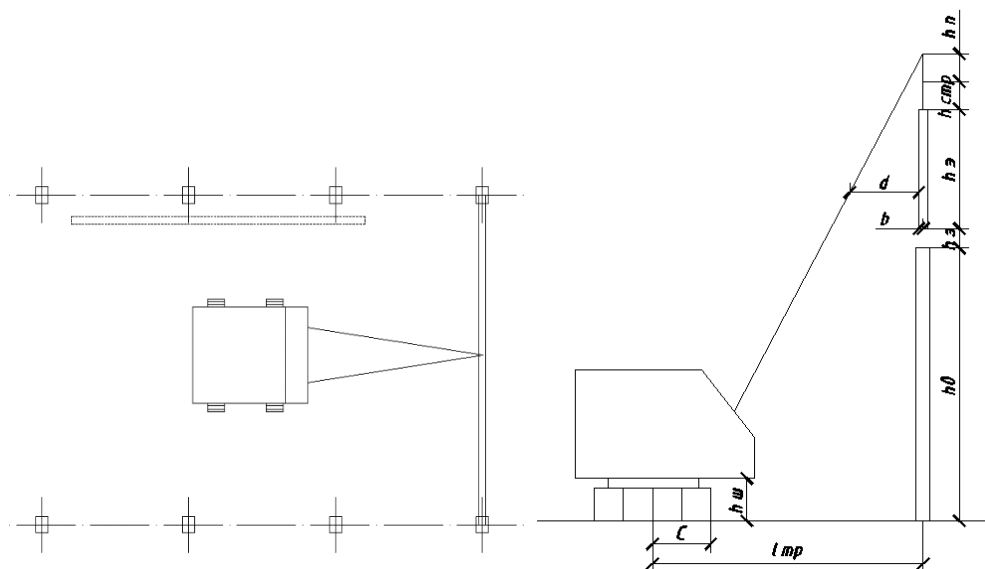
Схема для определения технических параметров крана для монтажа стропильной фермы
